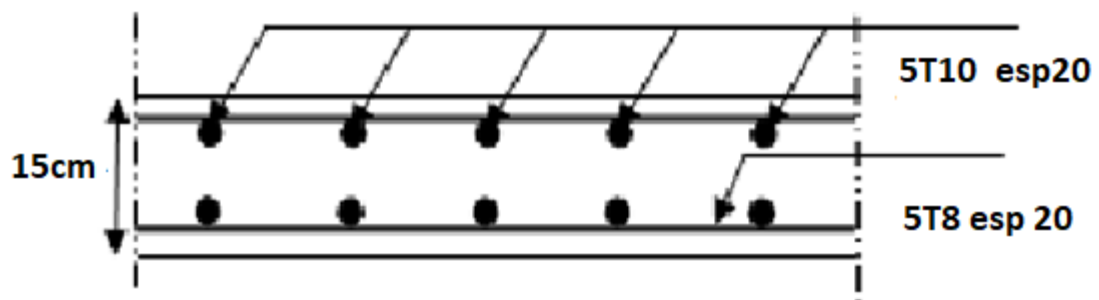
Coupe horizontale du ferrailage du voile périphérique.
